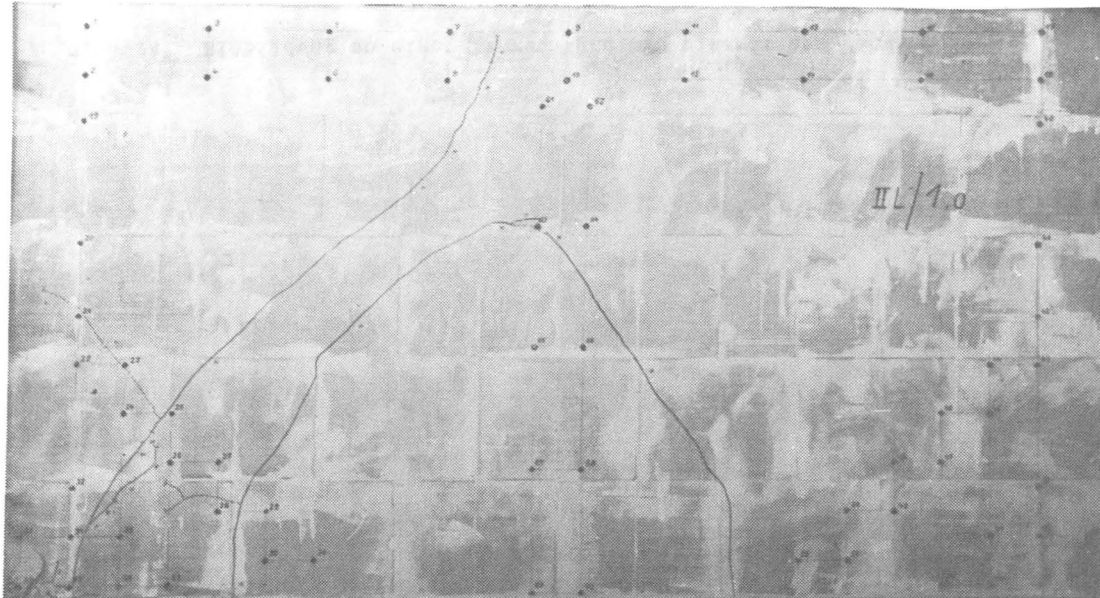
Rißbildung bei einer langen Wand mit kraftschlüssigem Randanschluß
